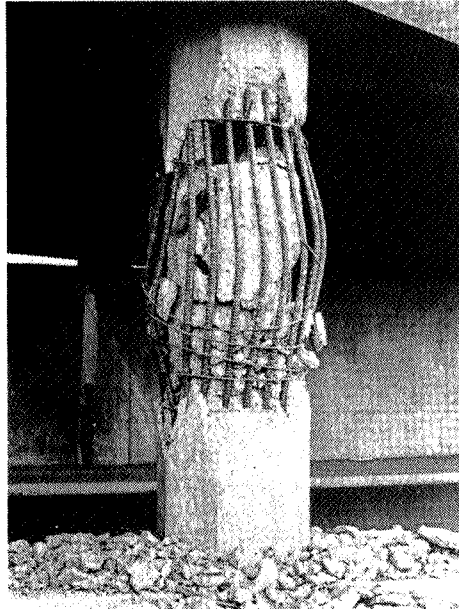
Ecrasement d'une pile de pont. San Fernando (1971).
